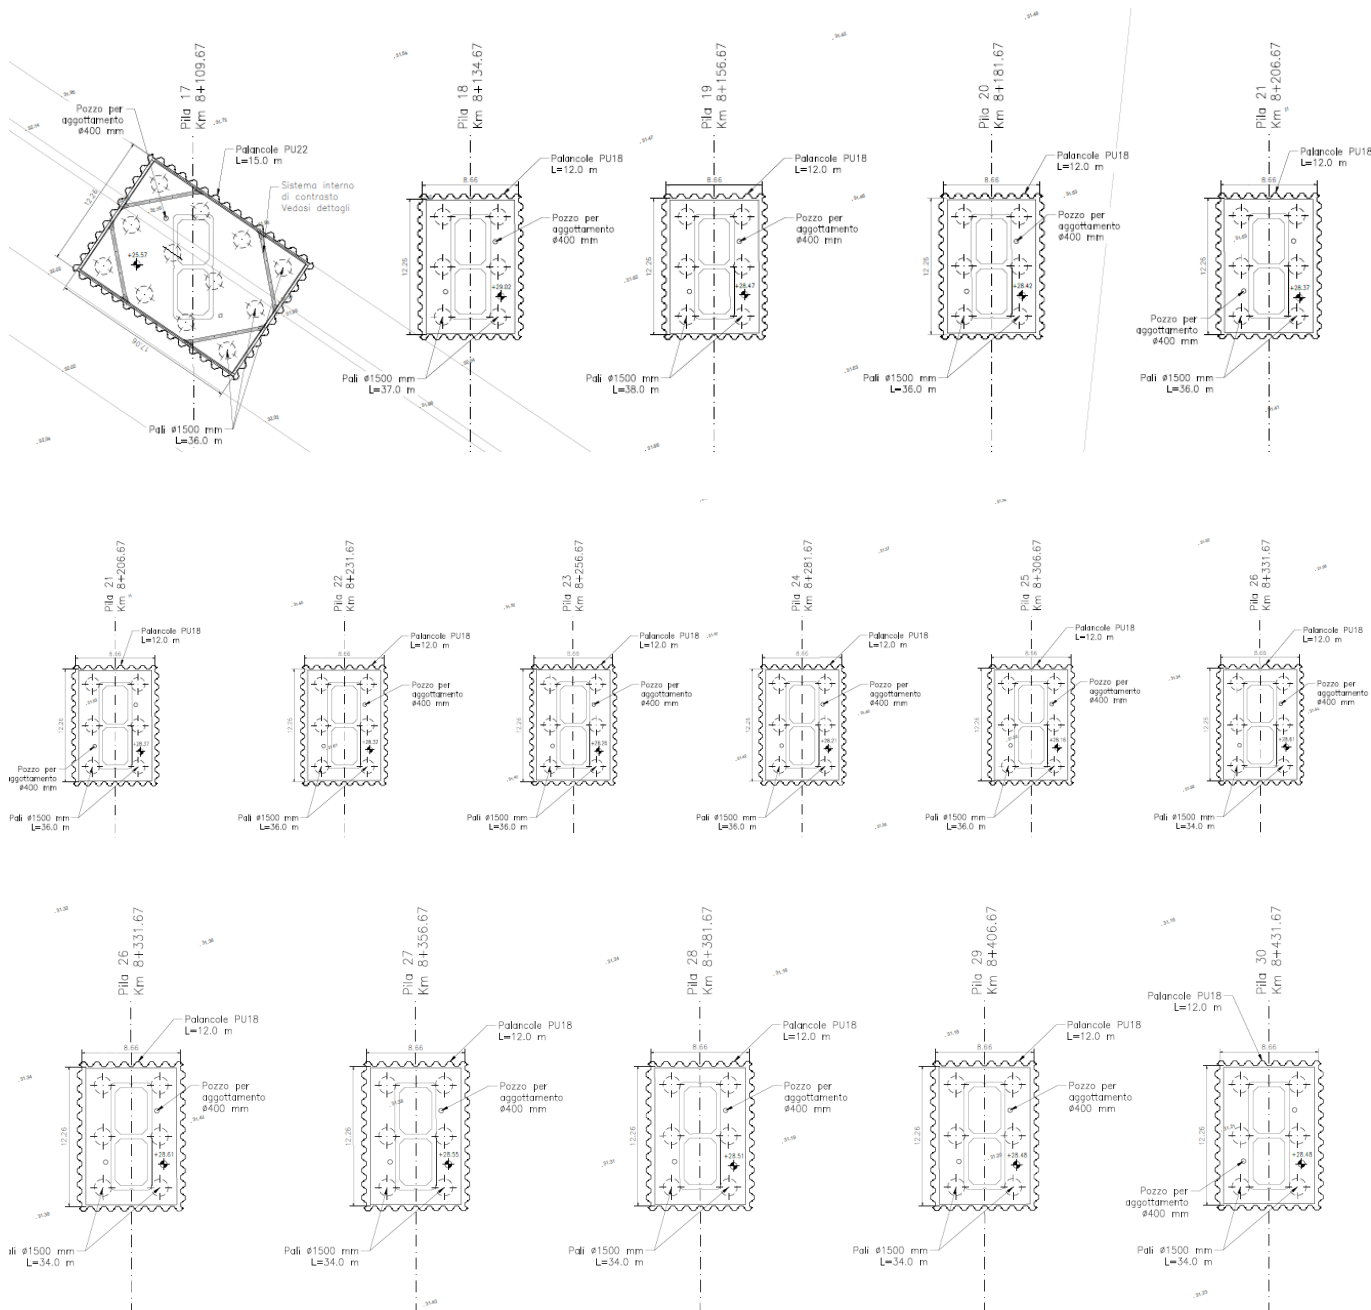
Pianta opere provvisori (segue da pagina precedente)
